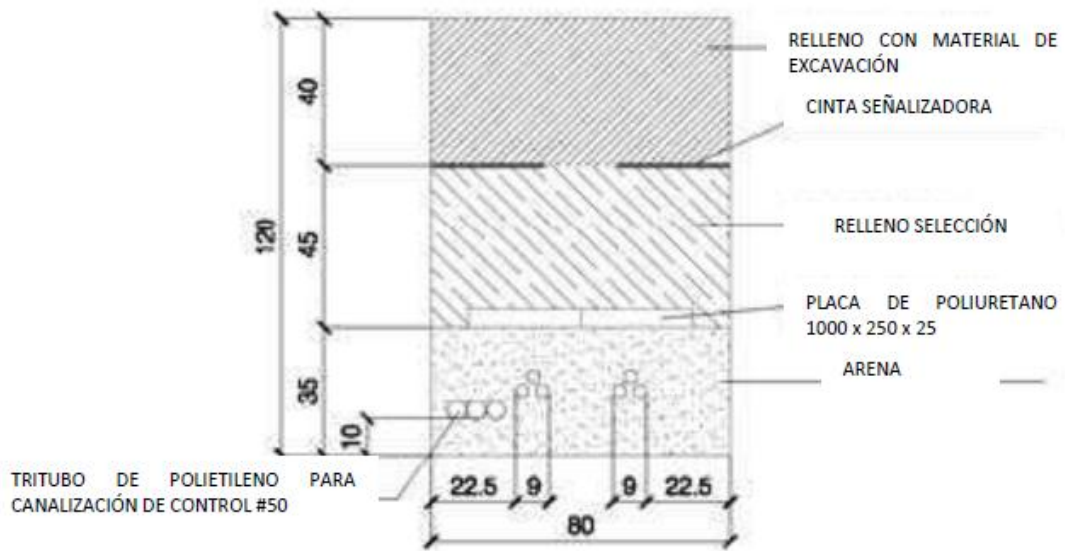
Disposición de cables de potencia en la Sección Zanja Tipo II.
